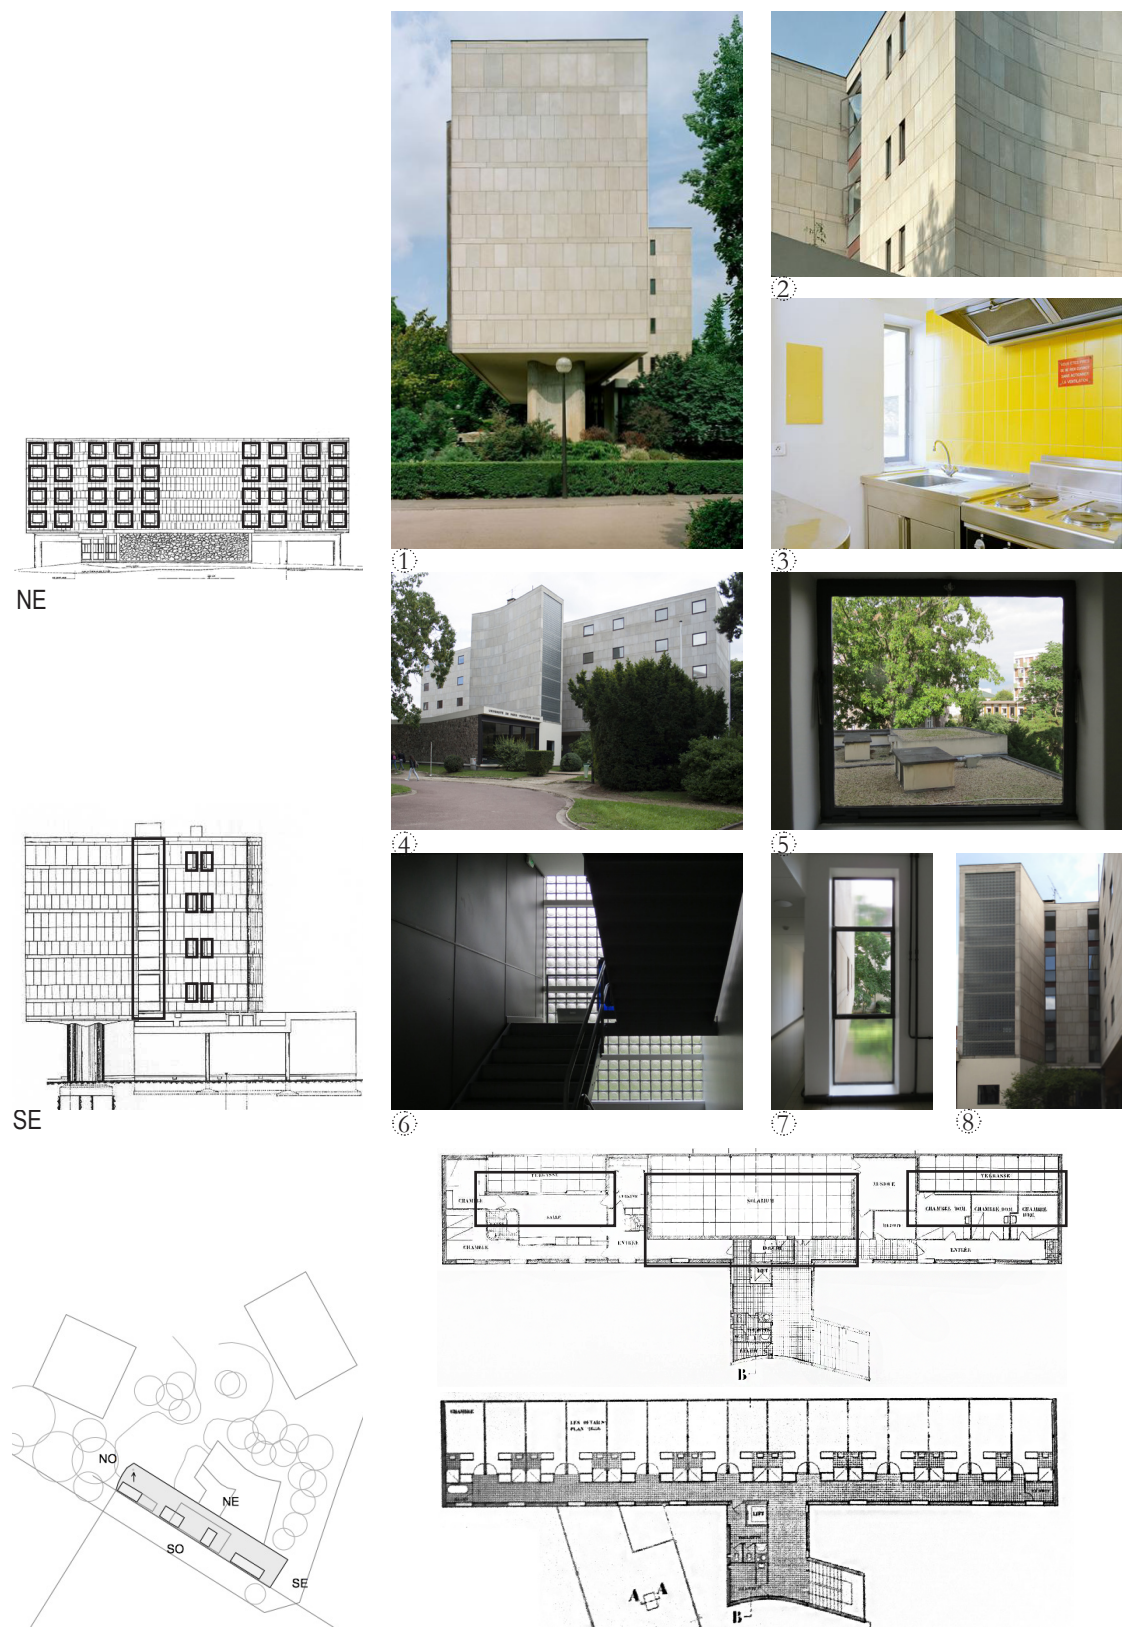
| Vãos das restantes fachadas do Pavilhão Suíço
